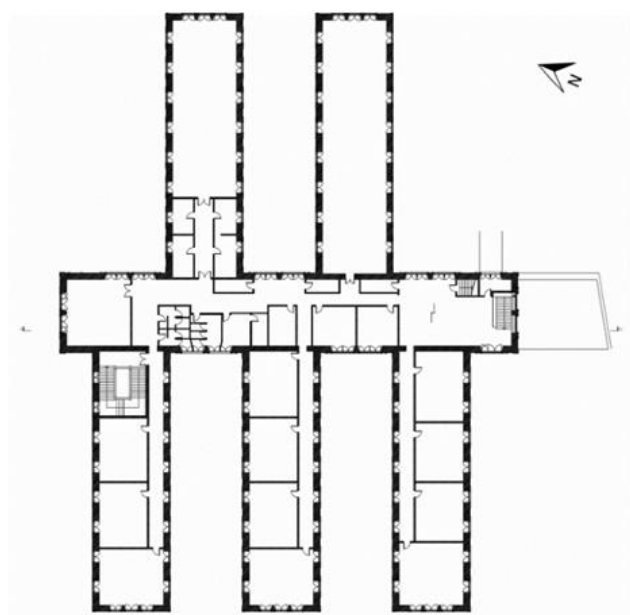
Planta 2º Andar. Fonte: C.M. Caldas da Rainha
